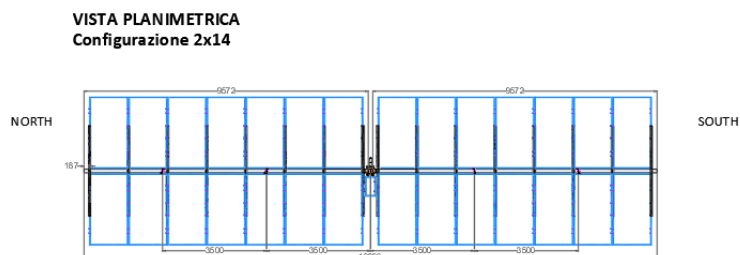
Vista planimetrica delle strutture porta-moduli tracker 2x14
